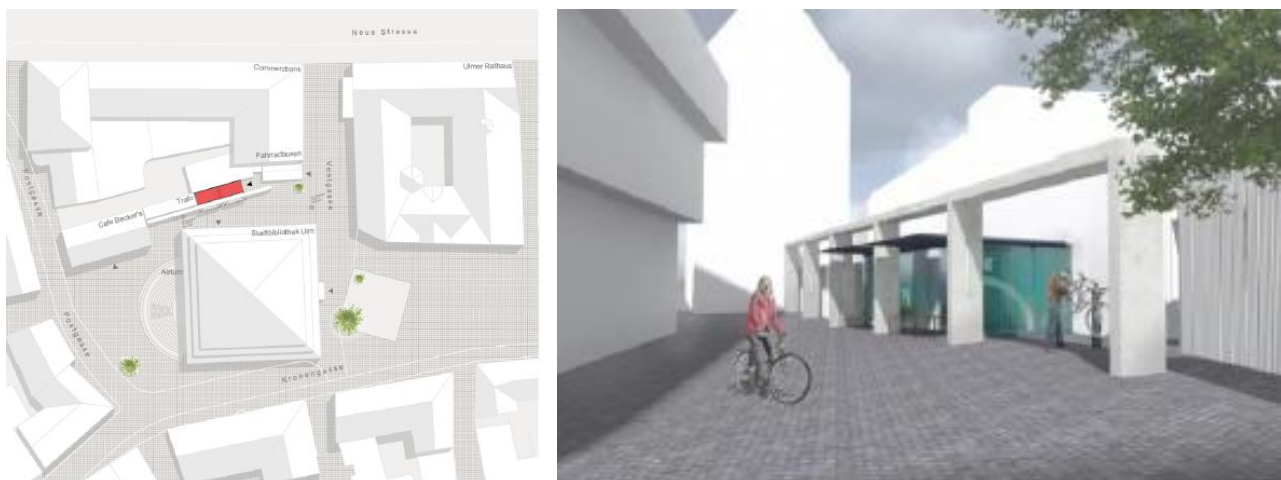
Lageplan und Grafik des Verleihgebäudes
